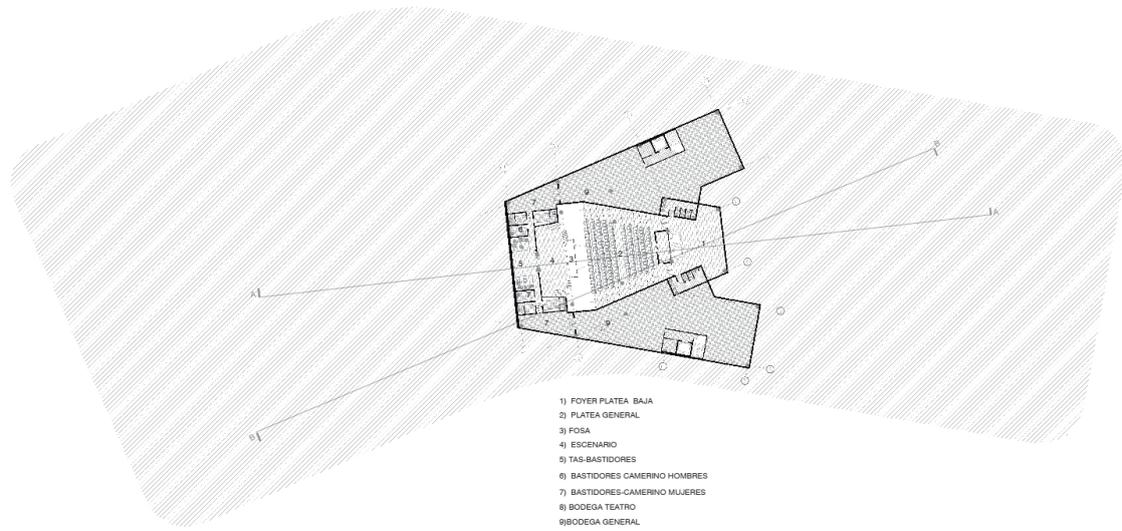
Planta PB + 21.00m. Elaboración propia.
